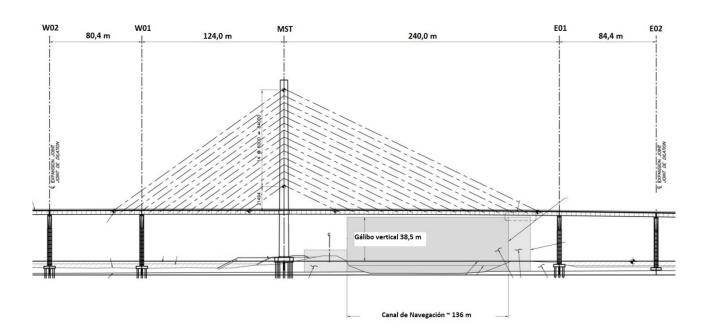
Alzado general del tramo atirantado del Nuevo Puente de Champlain.
